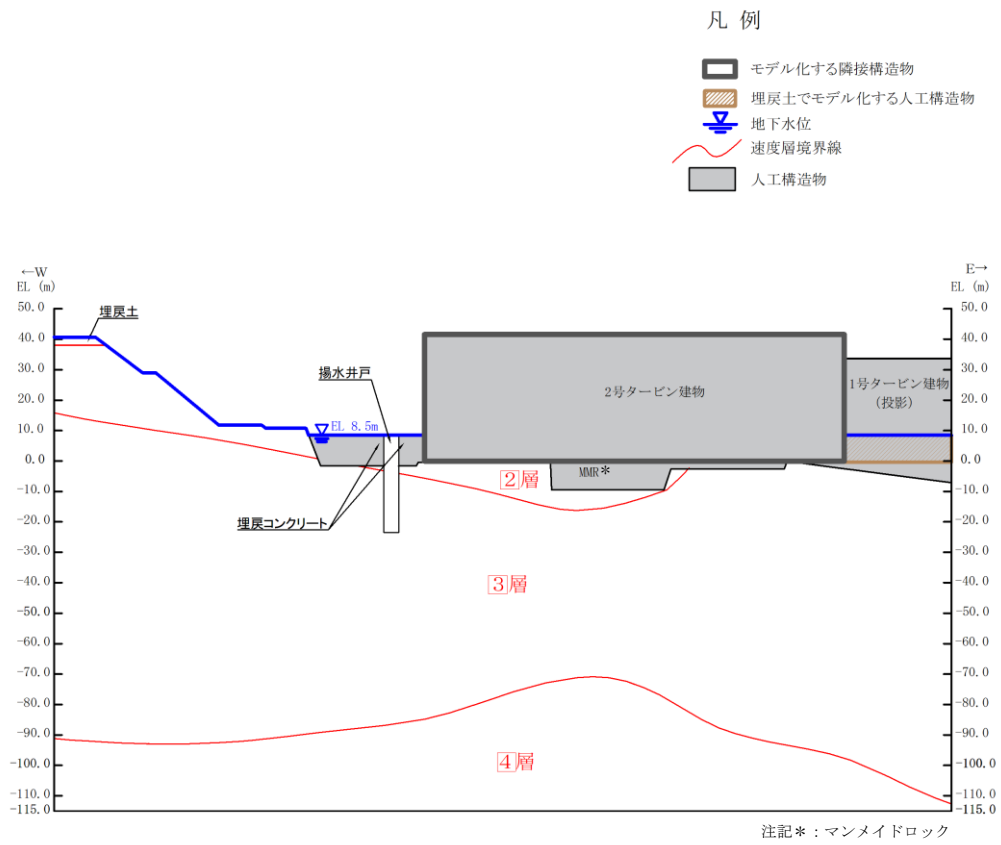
評価対象断面図 (A-A 断面 (東西方向))
